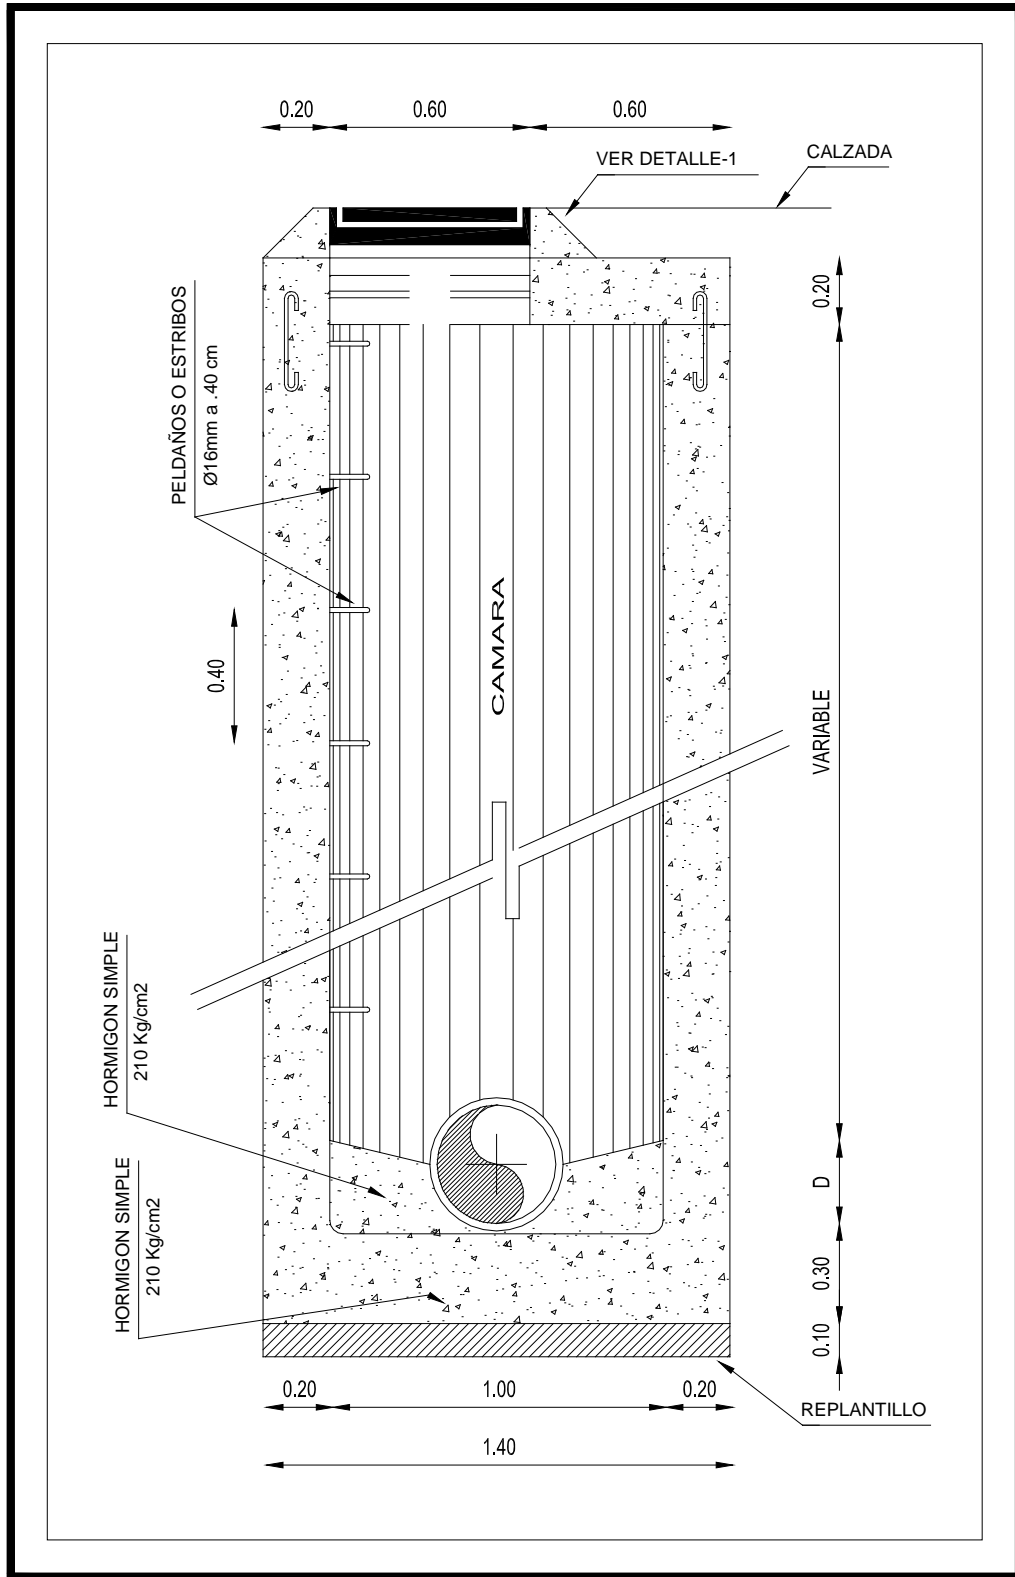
Corte de un Pozo de Revisión Tipo
